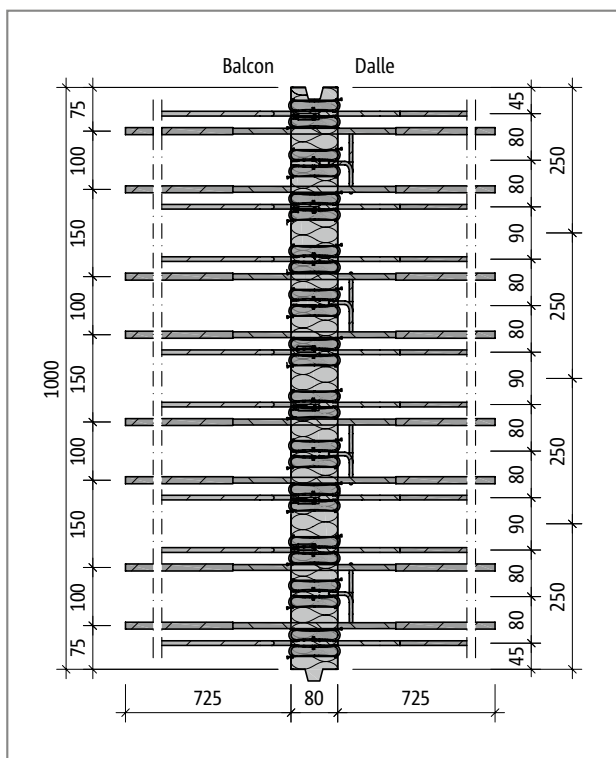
Schöck Isokorb® T Type K-E-M6 : Plan de base du produit
